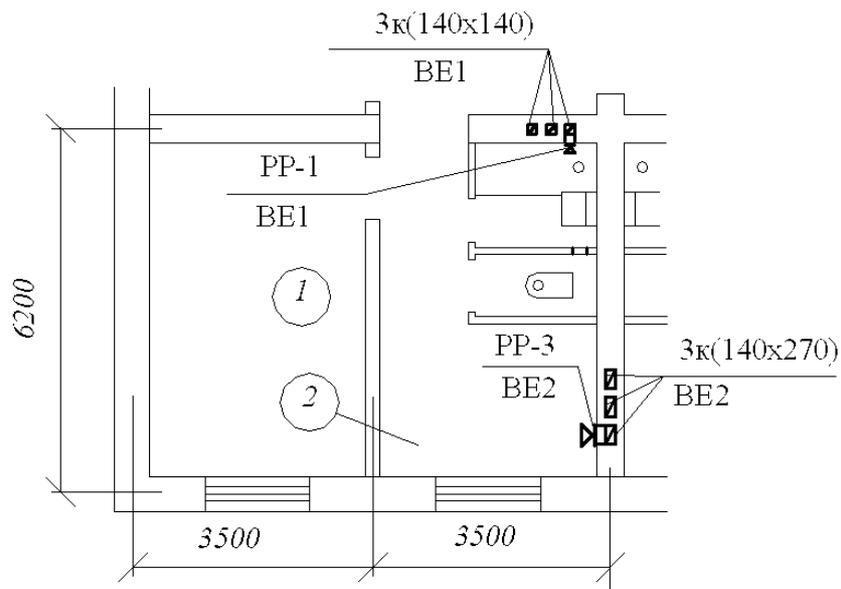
План однокомнатной квартиры третьего этажа с размещением систем вентиляции
